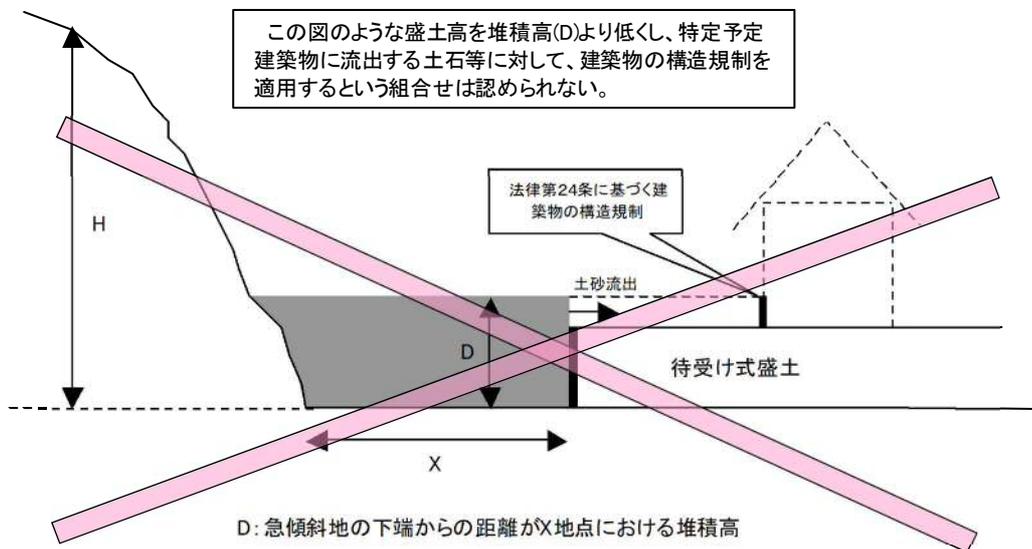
待受け式盛土及び建築物の構造規制の組み合わせ
